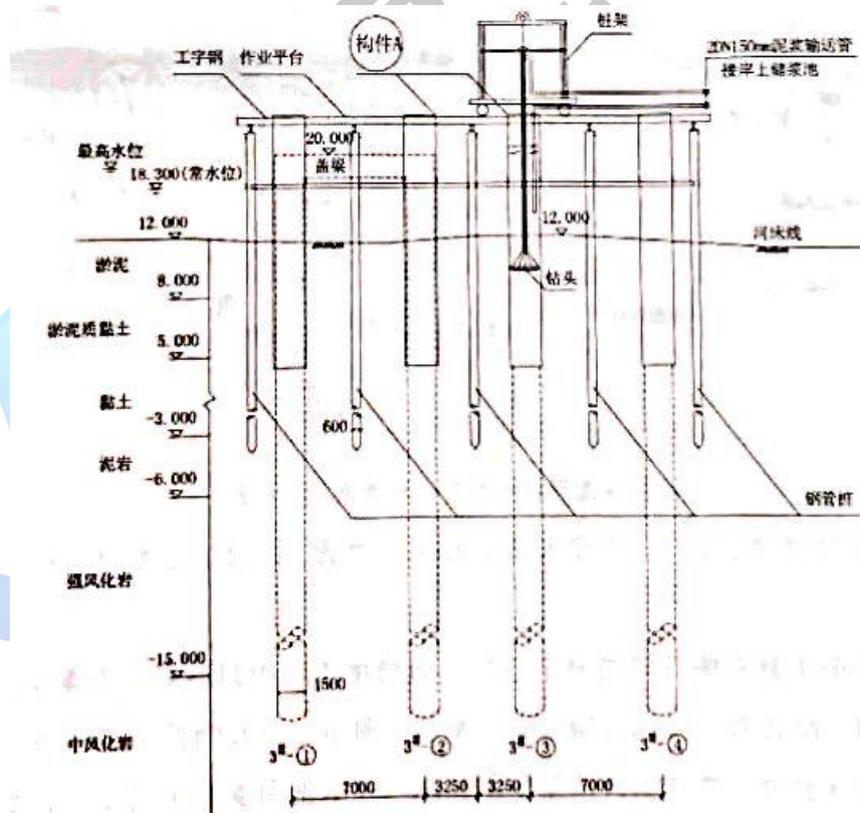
3#墩水上作业平台及桩基施工横断面布置示意图
